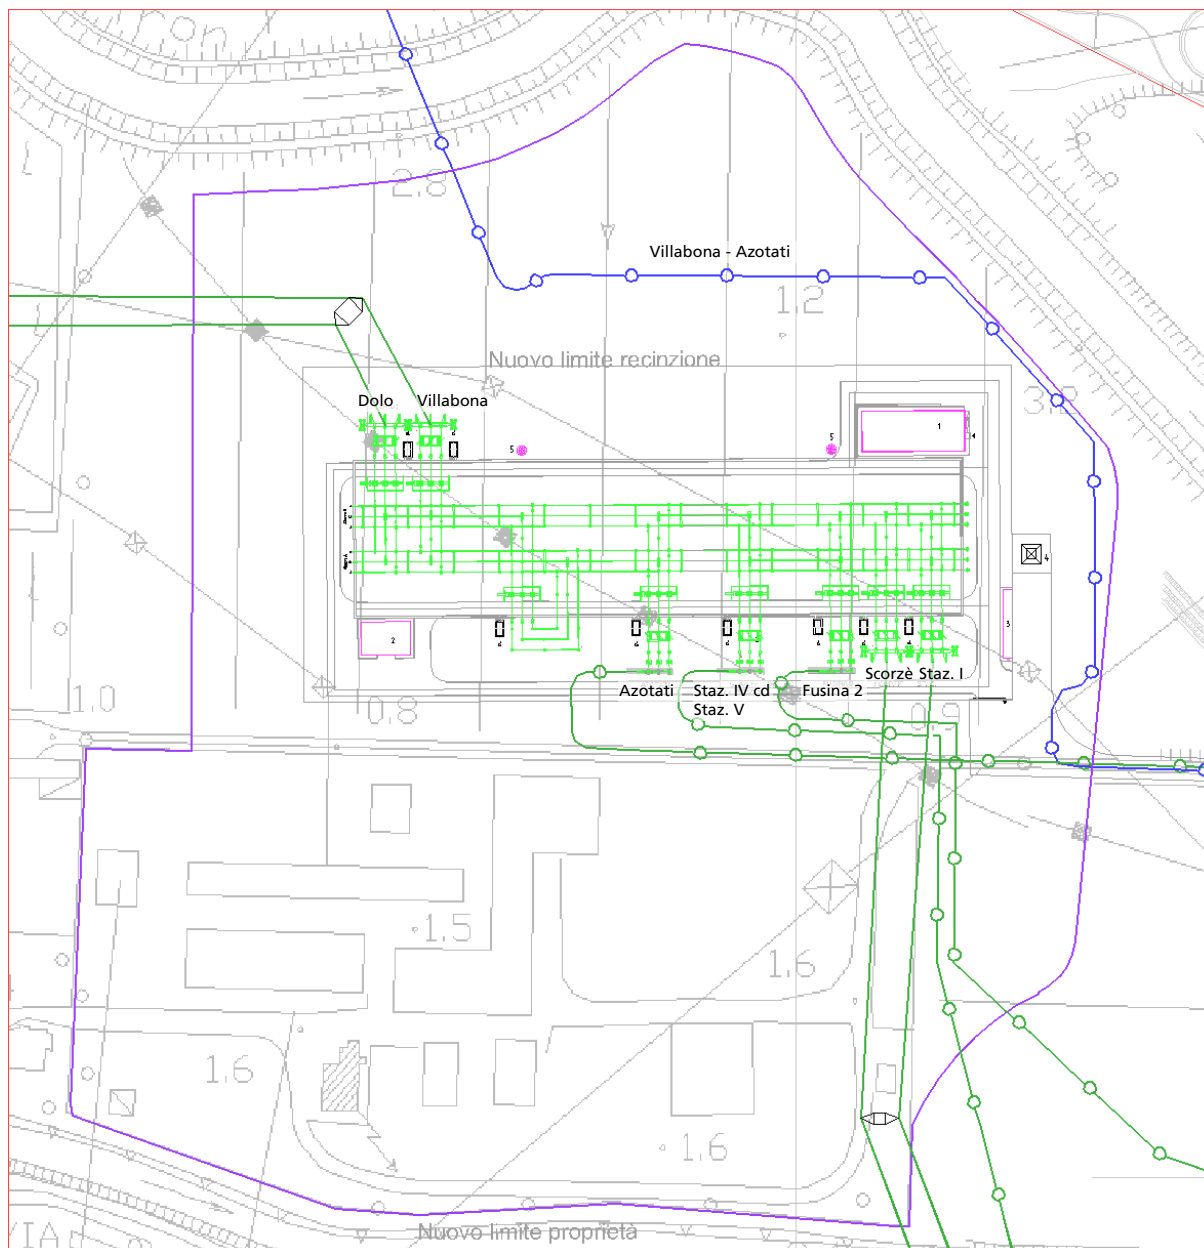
Planimetria della stazione “Malcontenta”. In verde i collegamenti a 220 kV e in blu il collegamento a 132 kV.
